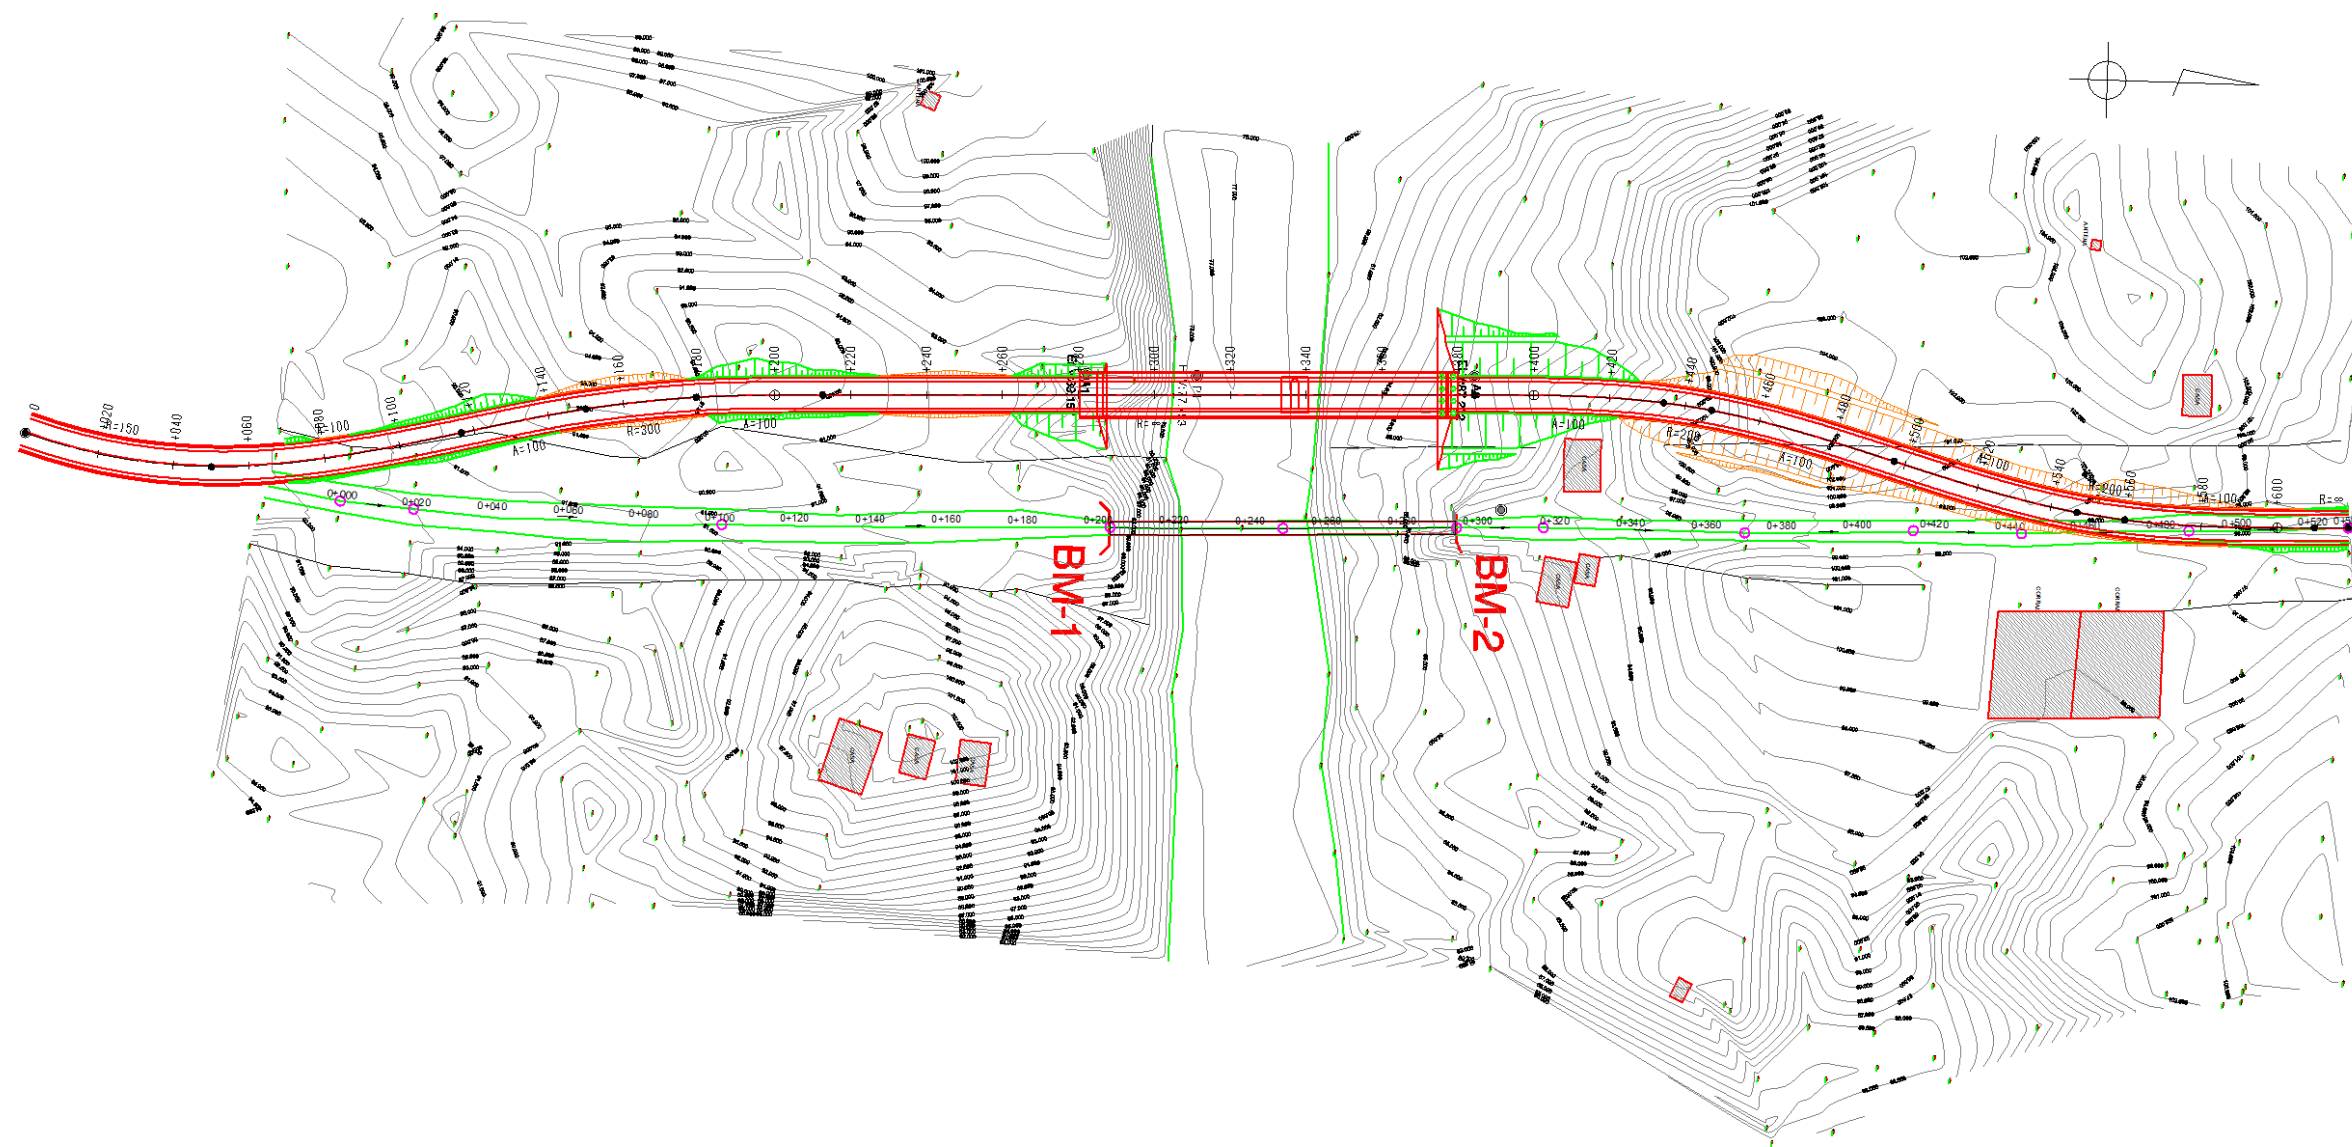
Plano de perfil longitudinal del camino de acceso (Puente Lisawe)
